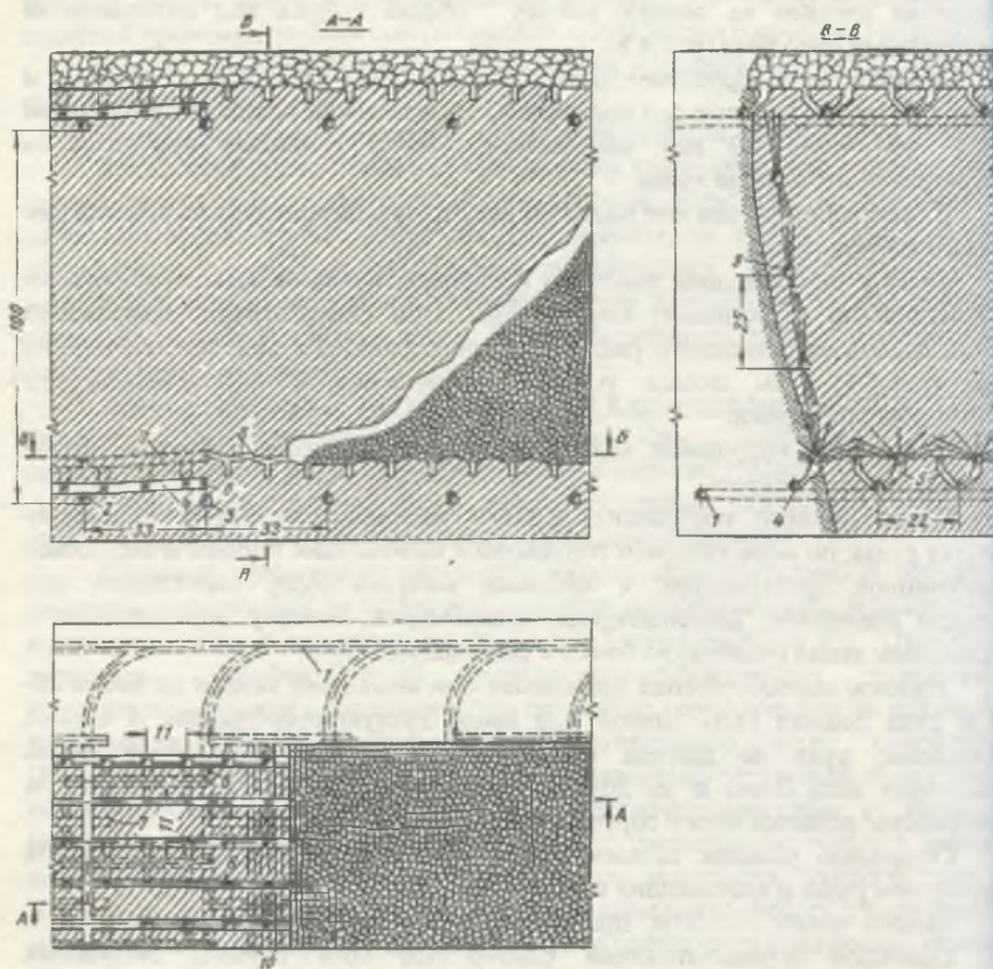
Этажное самообрушение, – вариант со сплошной выемкой (рудник “Клаймакс”):
